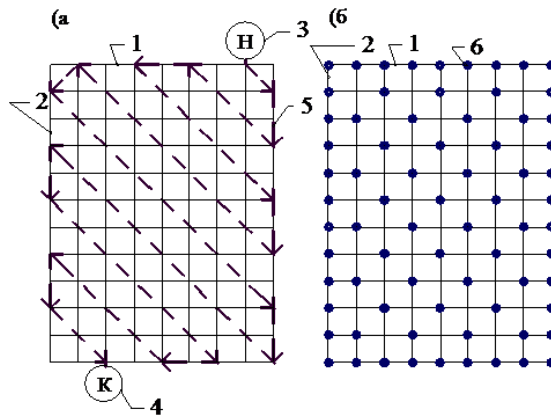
Порядок закрепления арматурных стержней вязальной проволокой:
